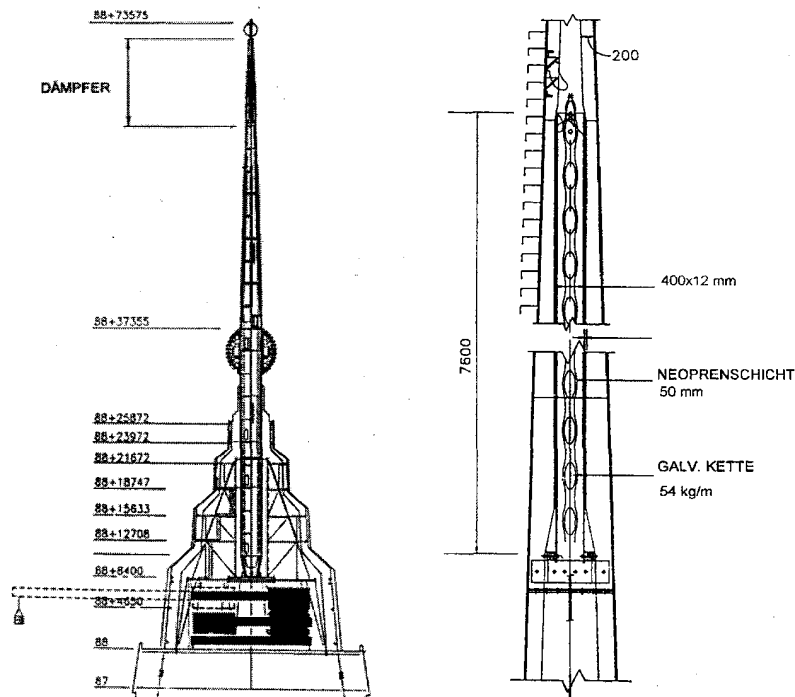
Struktur der Hochhausspitze und Ansicht des Stoßdämpfers im Mastbereich [10.24, 10.35]
